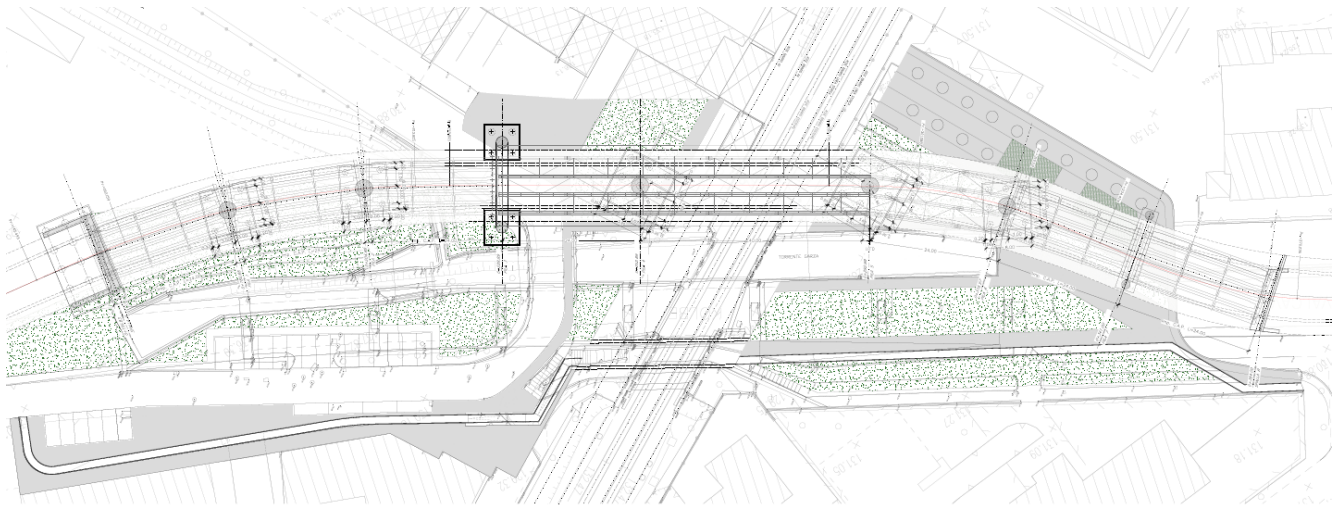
Stralcio planimetrico – ubicazione opera d'arte
